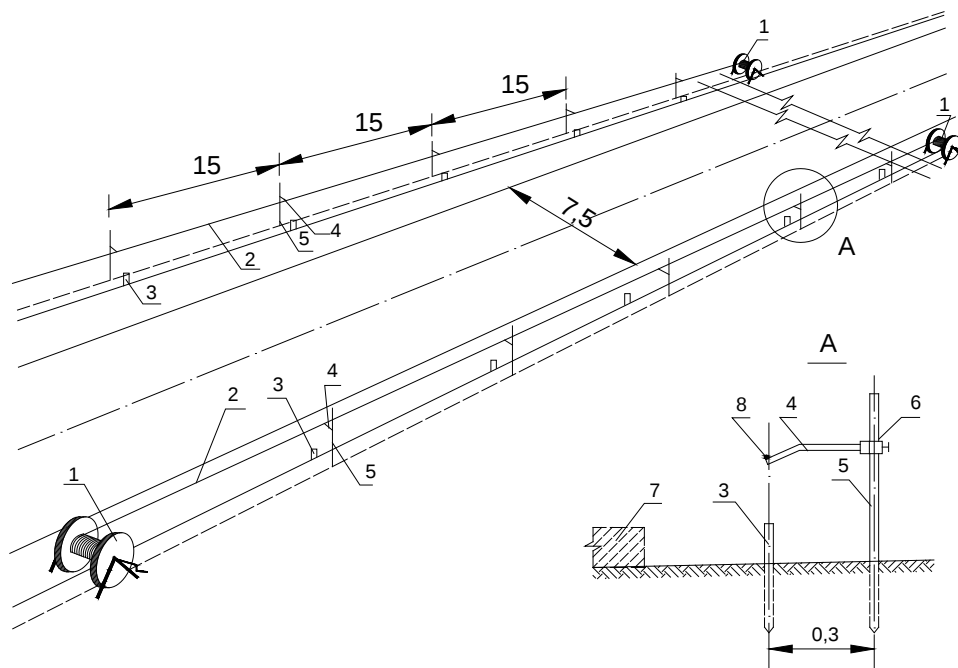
Planul schematic al sectorului de instalare a coardei de ghidaj.
